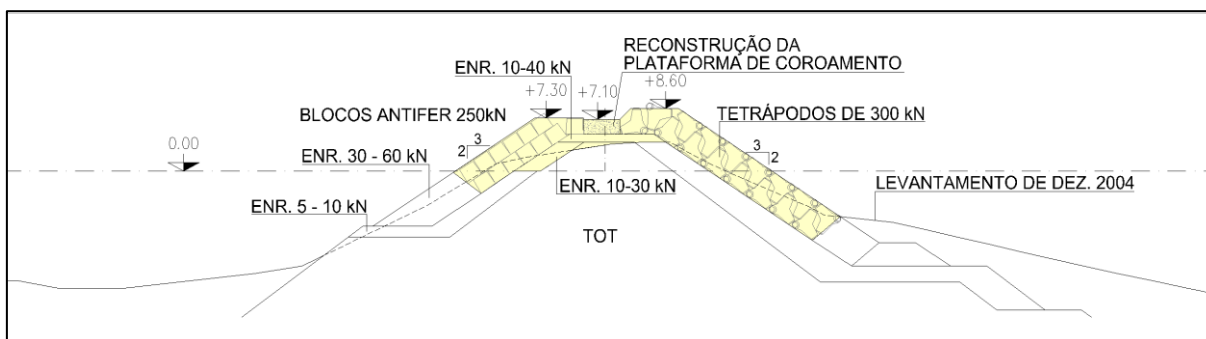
Perfil transversal tipo do Projeto de Execução da Reparação do Molhe Sul
